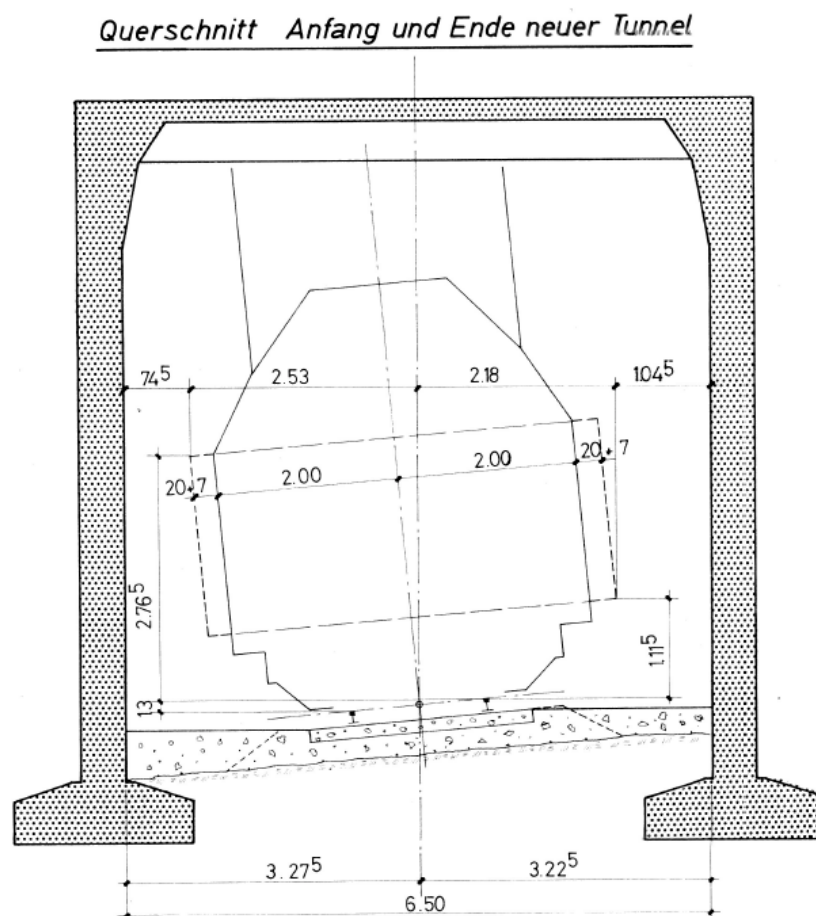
Normalprofil Tunnelverlängerung GHT I [5]
